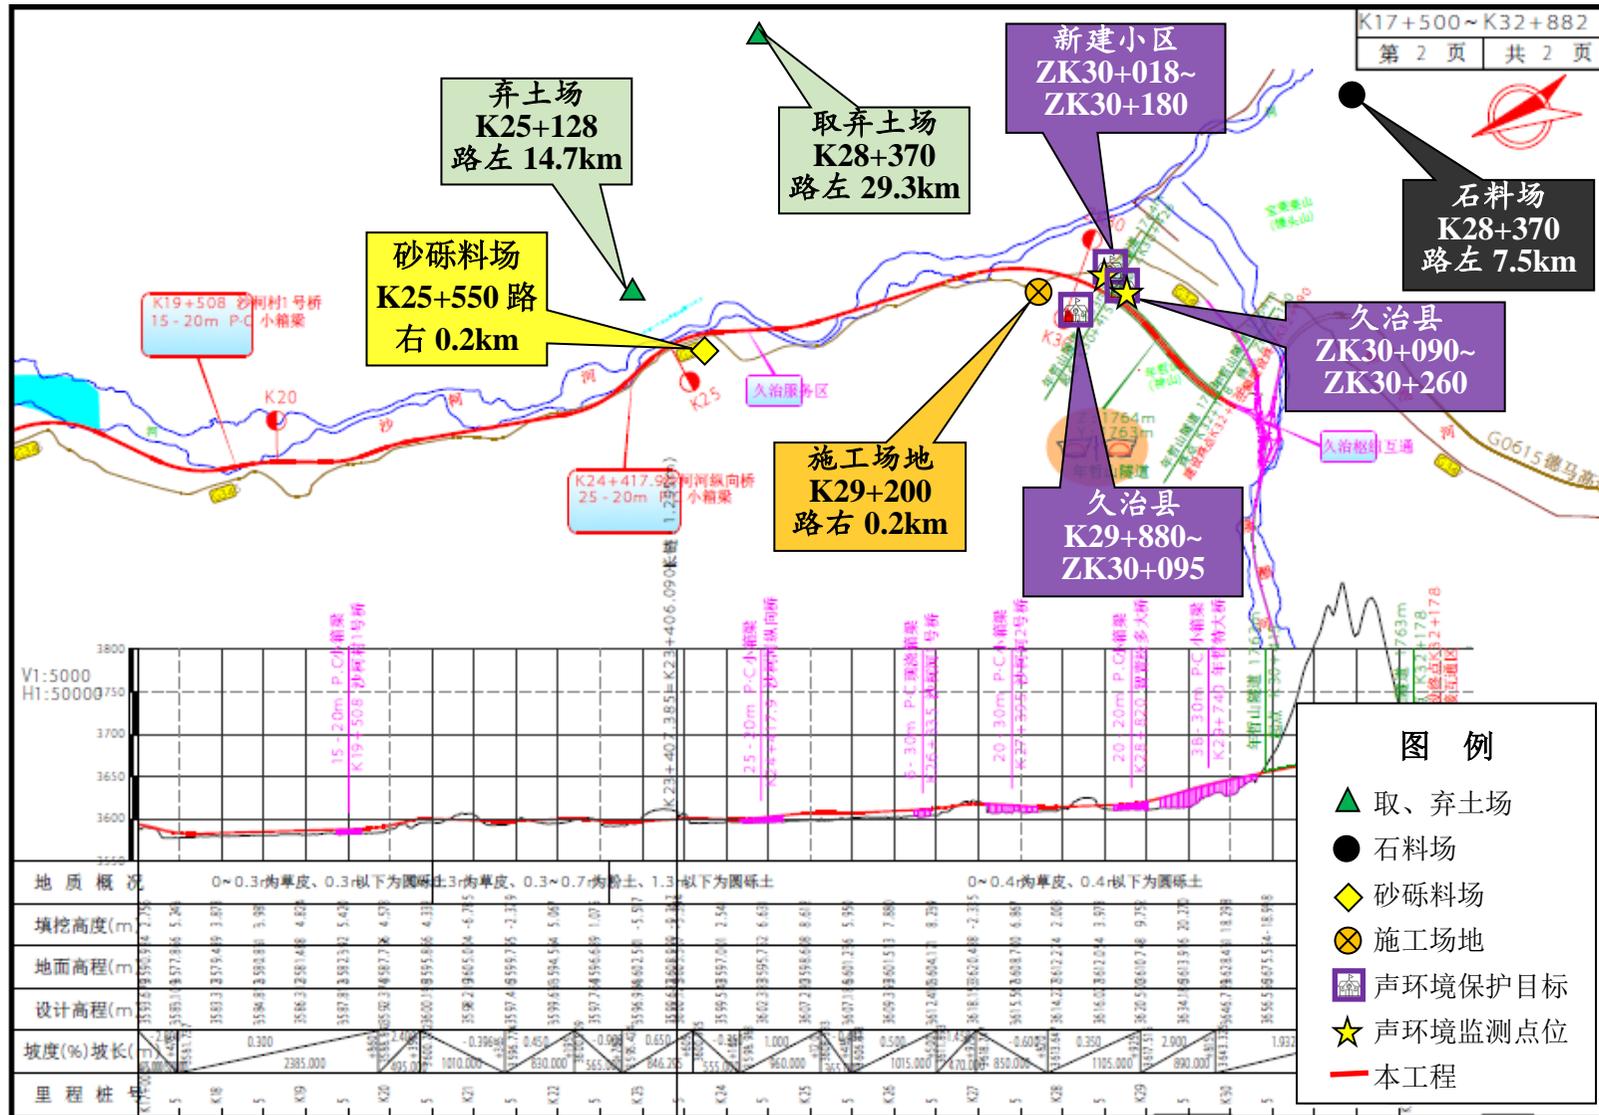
本工程路线走向及线位总体平面布置示意图 (2)
